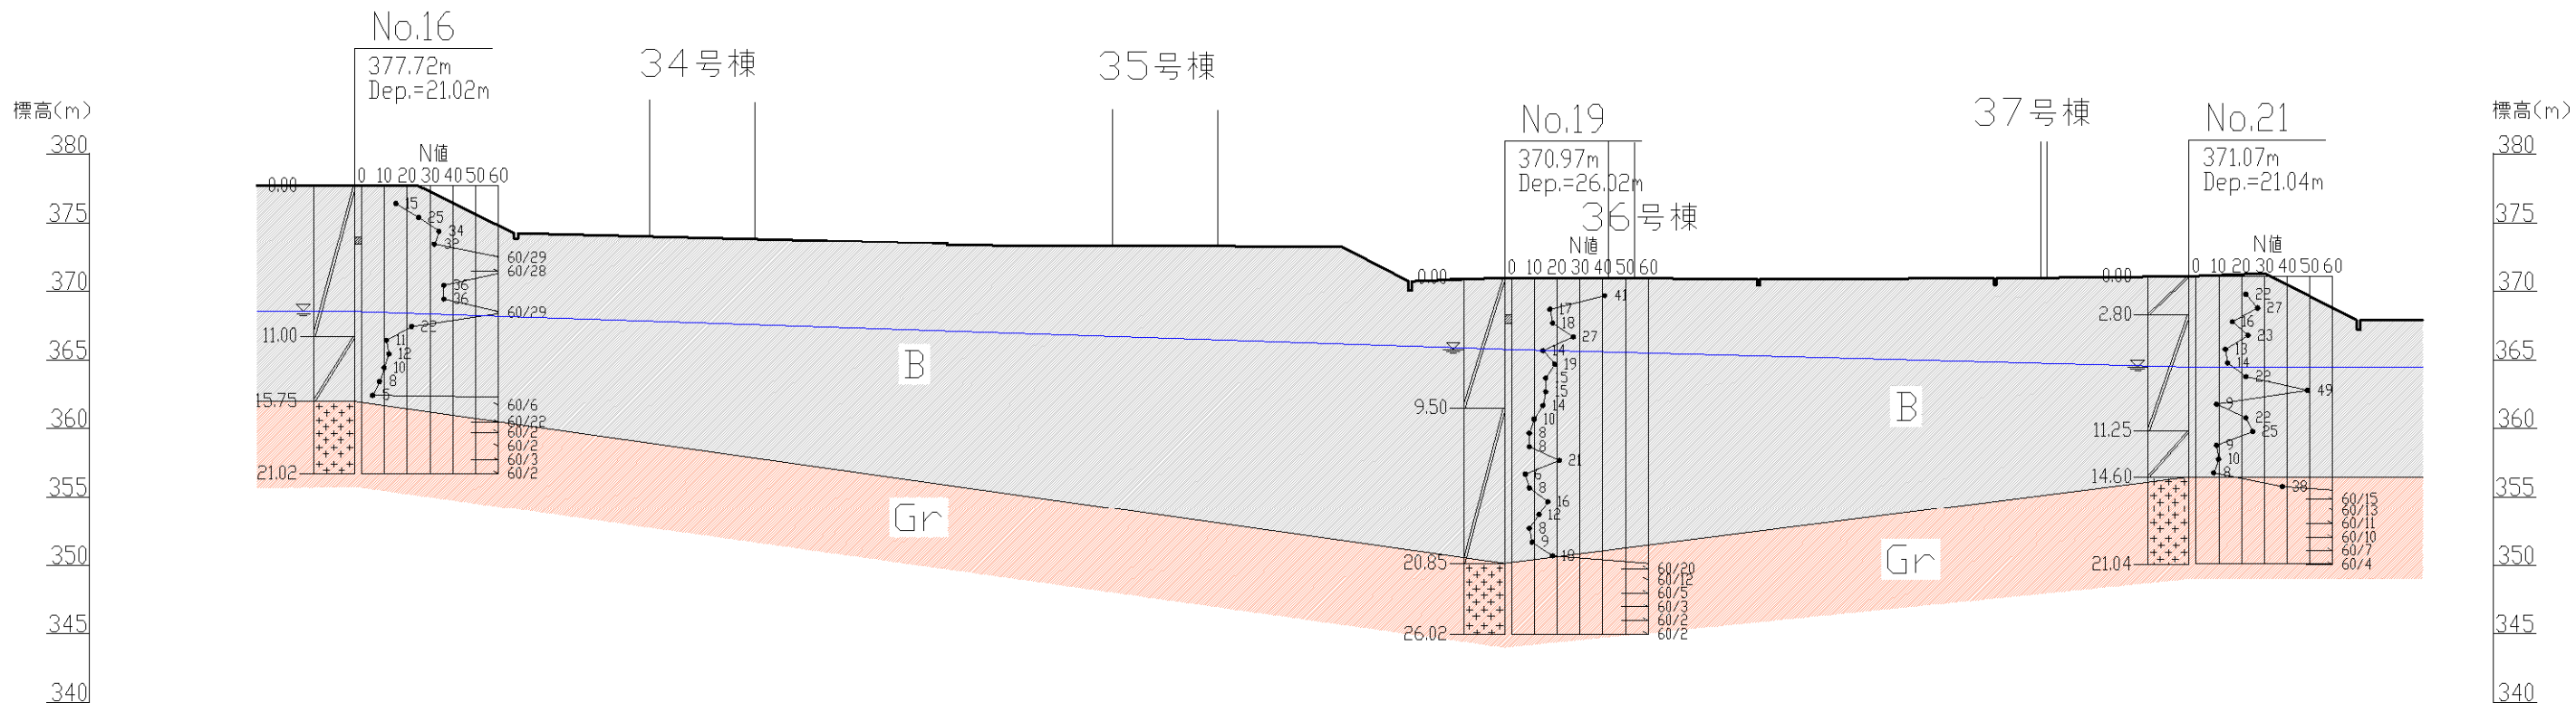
推定地質断面図 (No. 16~21) (S=1/500:A3)
